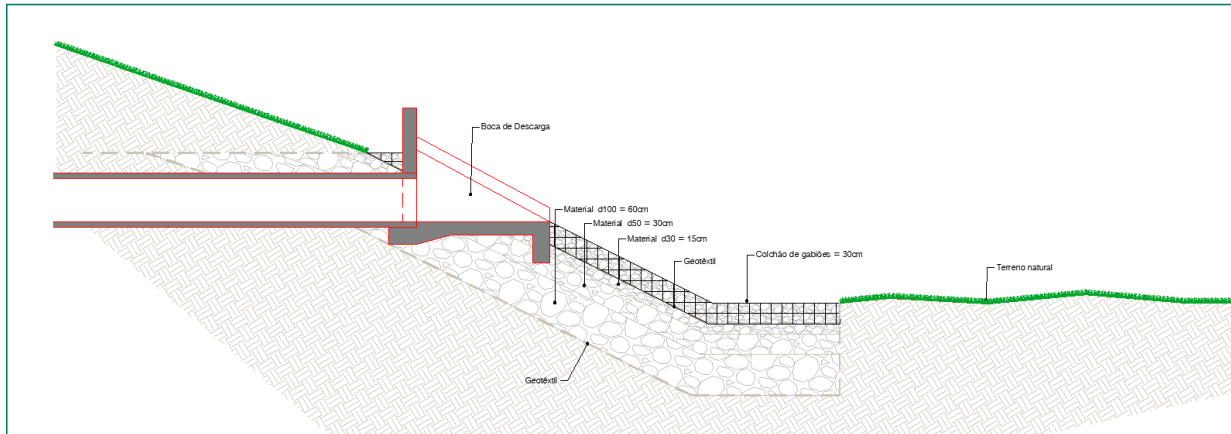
Pormenorização da Descarga de água pluviais nas bacias de infiltração
